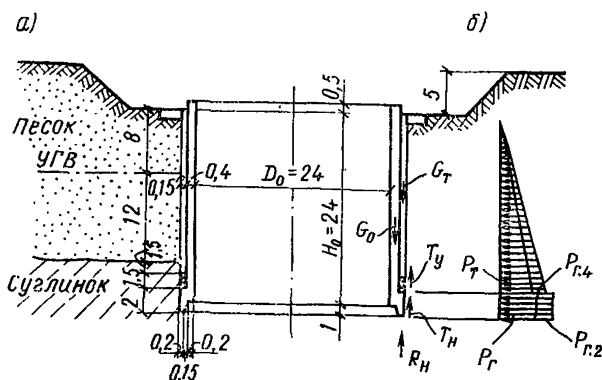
Схема круглого колодца (а) с расчетными нагрузками (б) в условиях погружения ниже горизонта грунтовых вод
